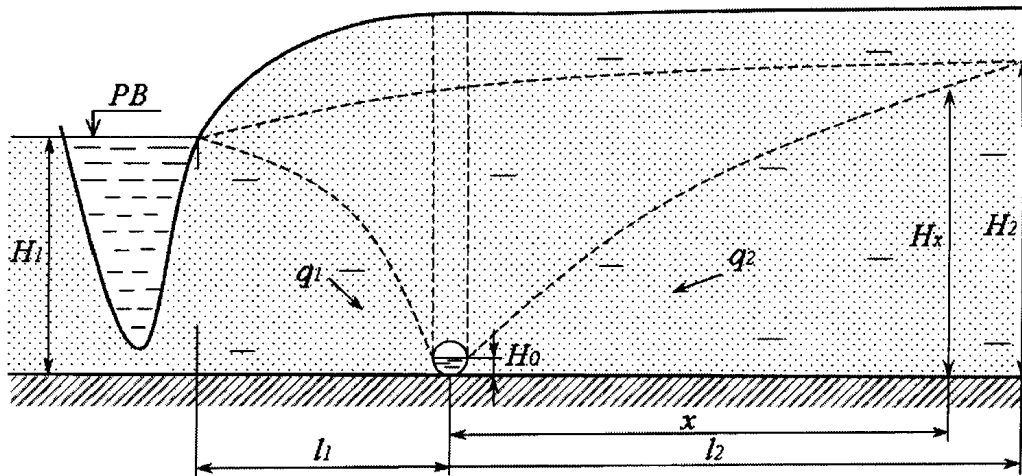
Схеми до розрахунку горизонтального однолінійного головного і берегового дренажу
